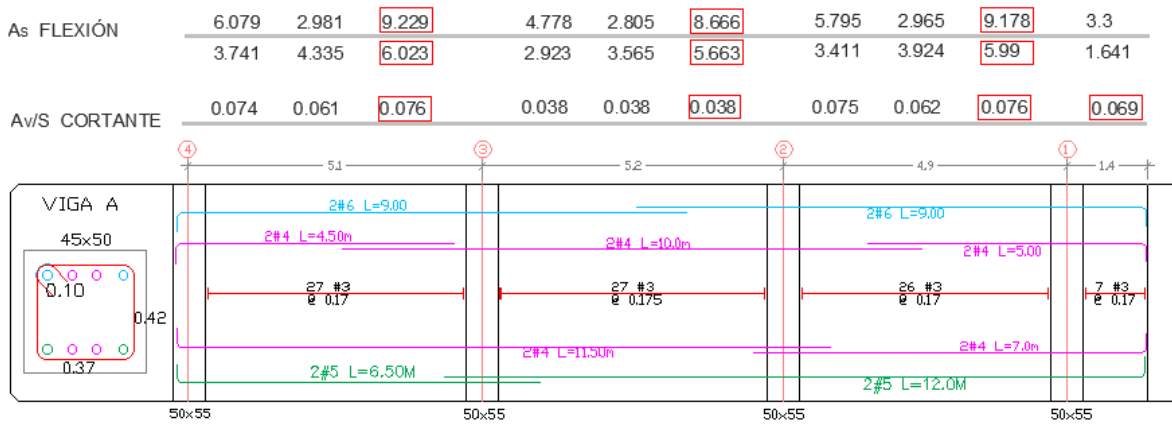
Cuantías obtenidas por esfuerzo a flexión, cortante y despiece de la viga A de la planta estructural. Fuente: elaboración propia.
